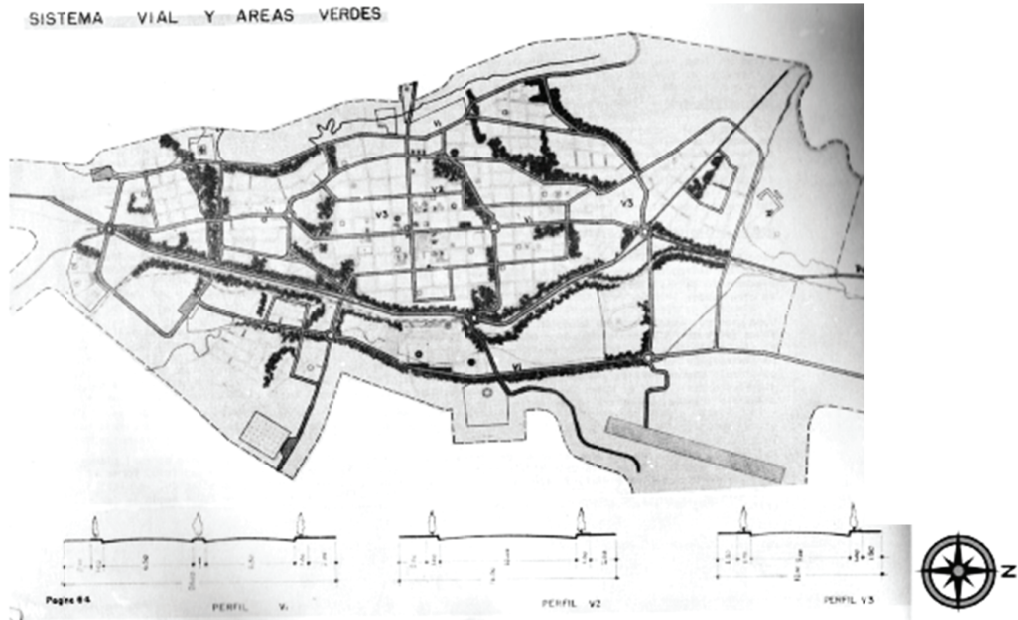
Plano del Sistema Vial y áreas Verdes del Plan Piloto de 1958
